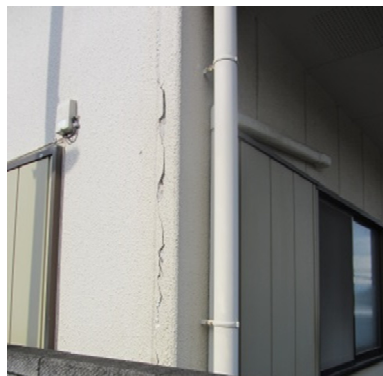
隅角部での ALC パネルのひび割れ
